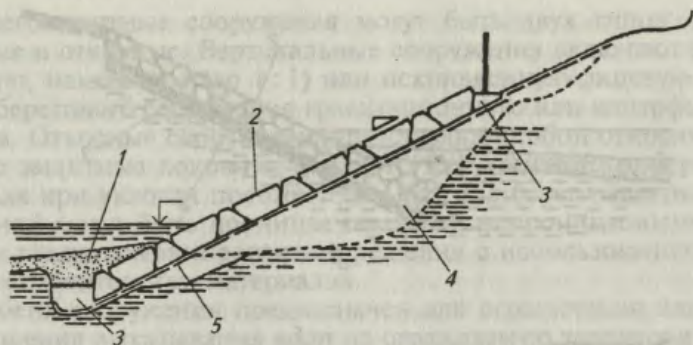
Бетонное крепление из клиновидных блоков:
